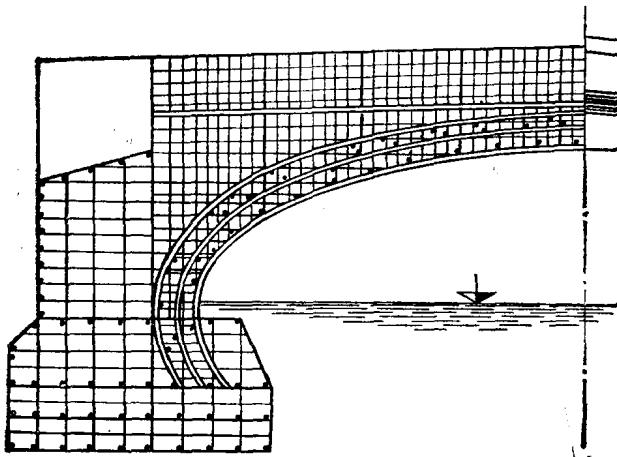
1873 年修建的第一座钢筋混凝土桥梁
